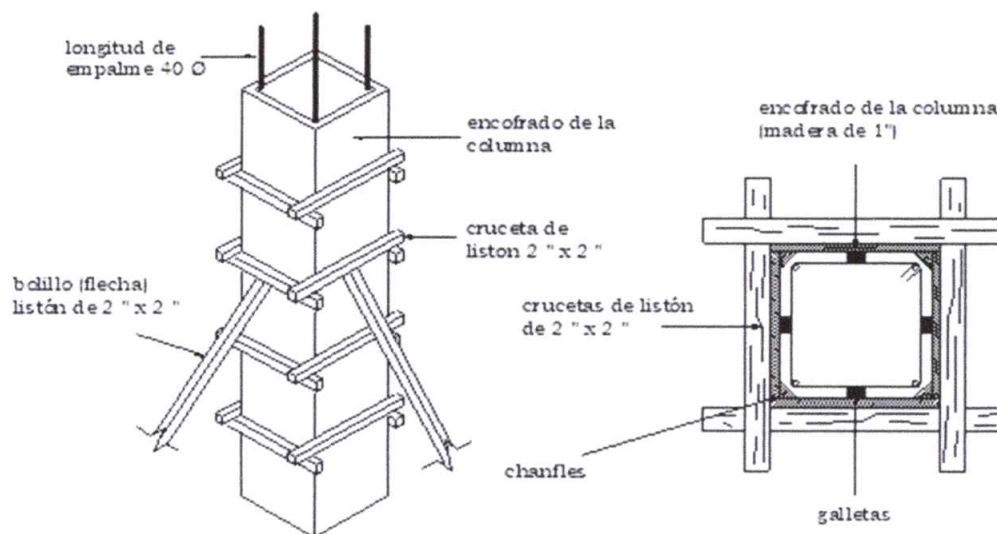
Esquema de columna. Fuente: Ingeniería real (2020)
